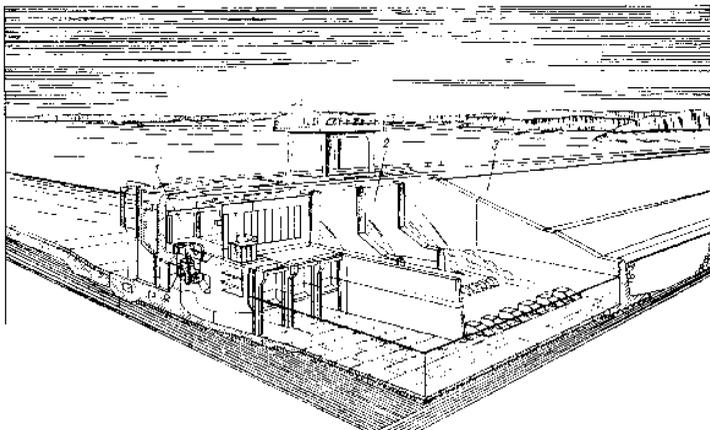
Гидроузел с русловым зданием ГЭС:
